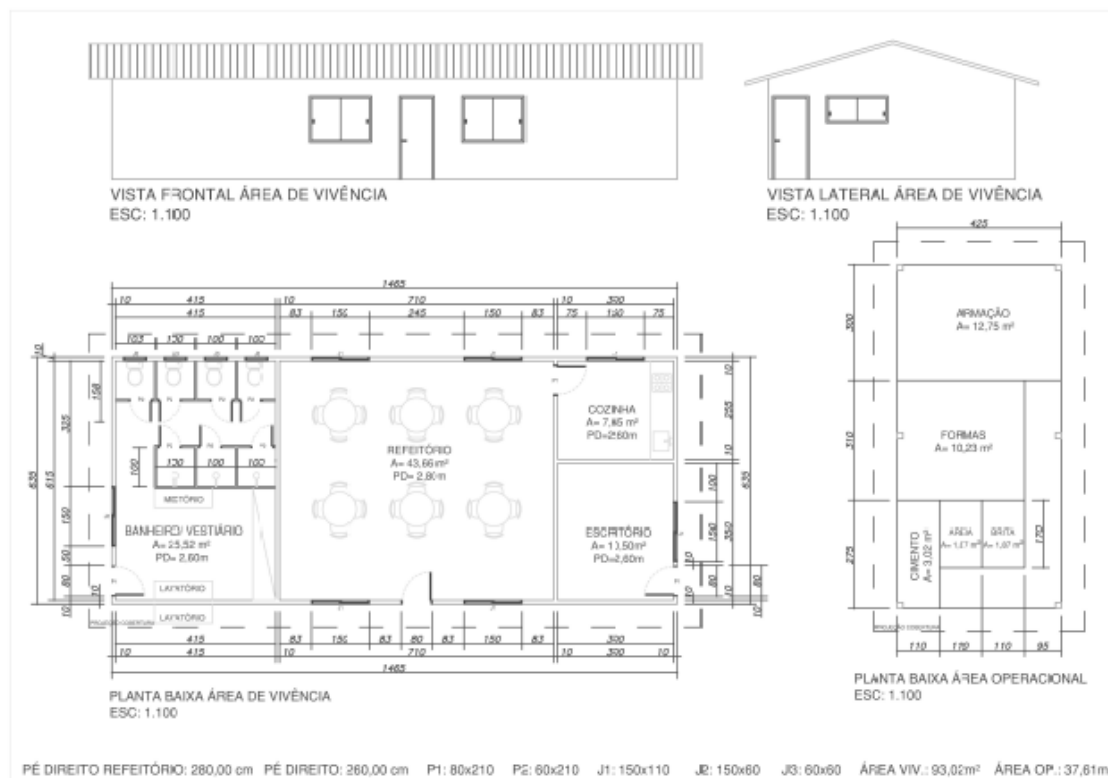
Planta baixa, vista lateral e frontal do canteiro de obras
